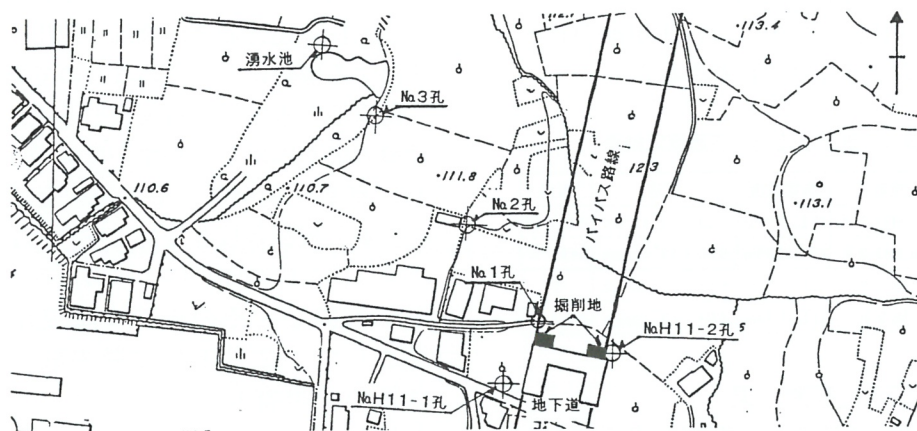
地下水調査地付近の平面図 (scale=1:2,500)
